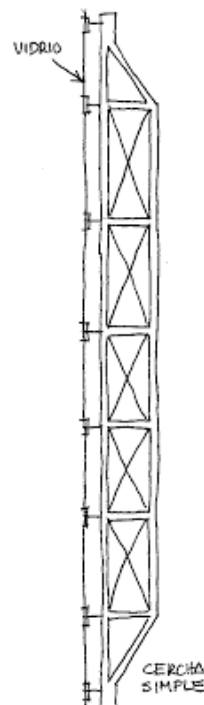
[Soporte de fachada de cercha simple] (Lauret, 2018)
